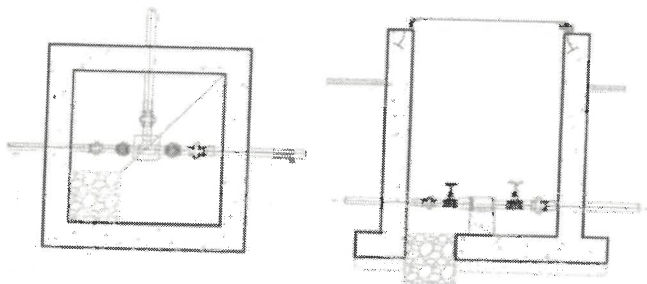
Planta y corte de válvula de control doble del sector Santa Rosa.
